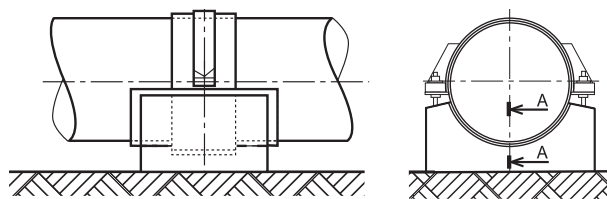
Анкеровка муфт к бетонным опорам
